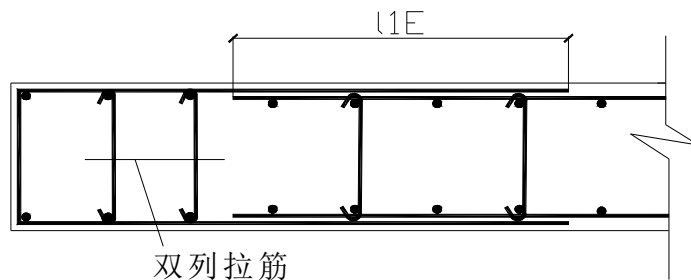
墙厚较小时剪力墙的水平钢筋在端部无暗柱时锚固示意图
